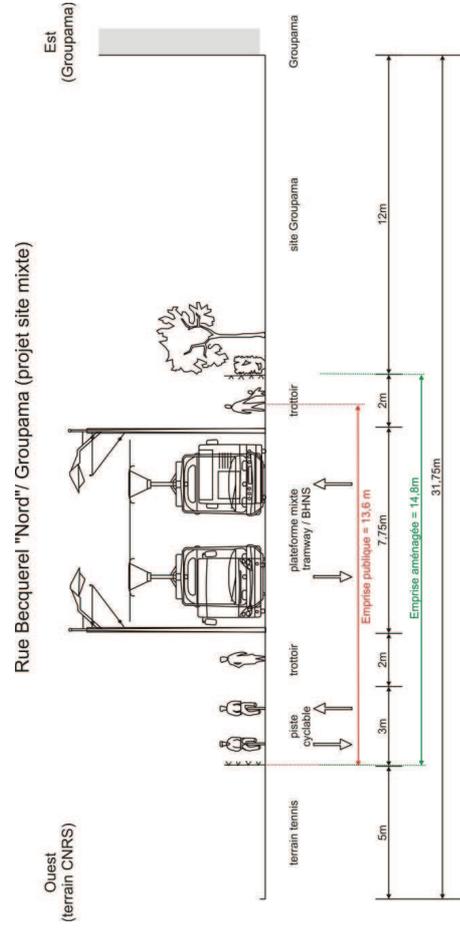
Situation projetée (coupe 25) rue Becquerel dans l'hypothèse d'un site mixte tram "D" +BHNS
